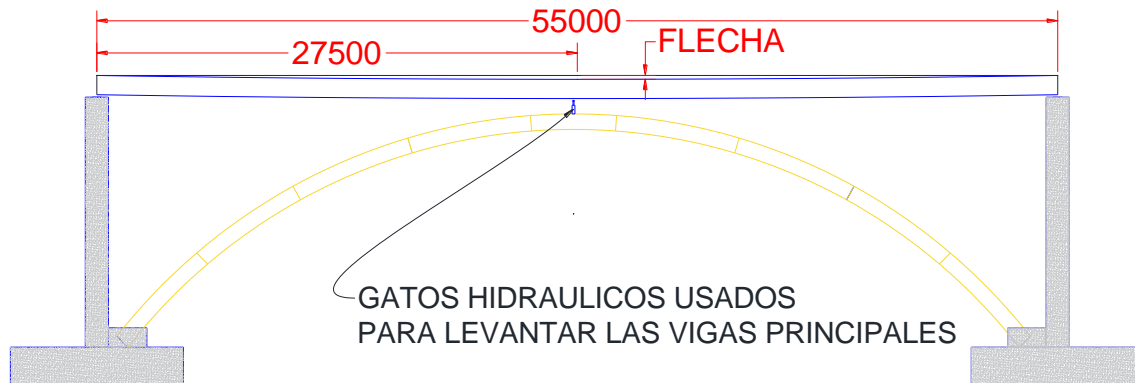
Colocación de los gatos hidráulicos para levantar las vigas principales y eliminar la flecha producida por el peso de las vigas.
